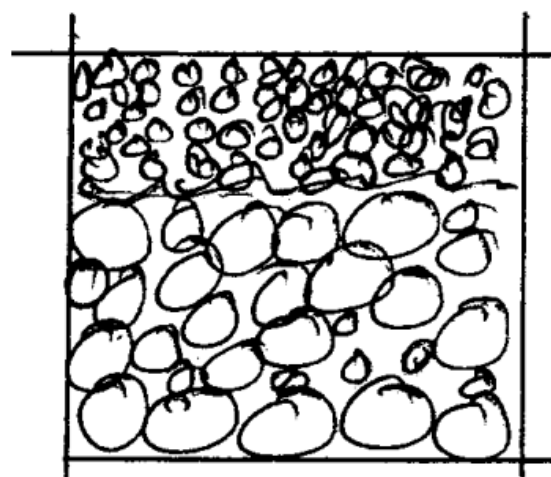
Typická struktura porézního asfaltového krytu [19]
